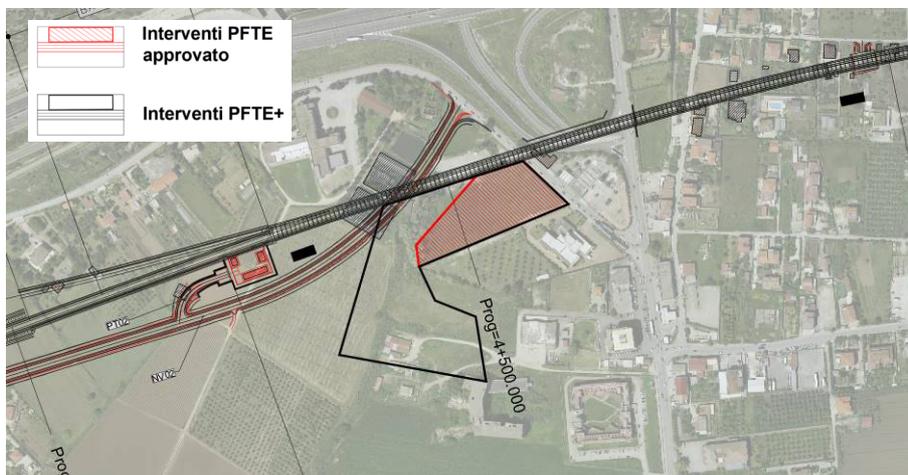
Modifiche all'area di cantiere AT.02. Sovrapposto cantieri con il sistema dei vincoli (in rosso il PFTE e in nero il PFTE+)
